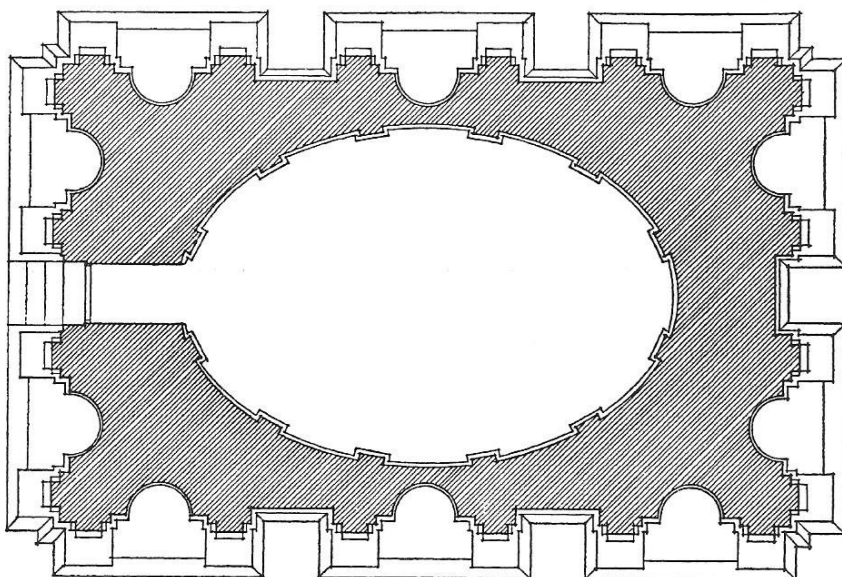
Michelangelo, Primeiro projeto do Túmulo de Julius II, plano de chão (reconstrução).
